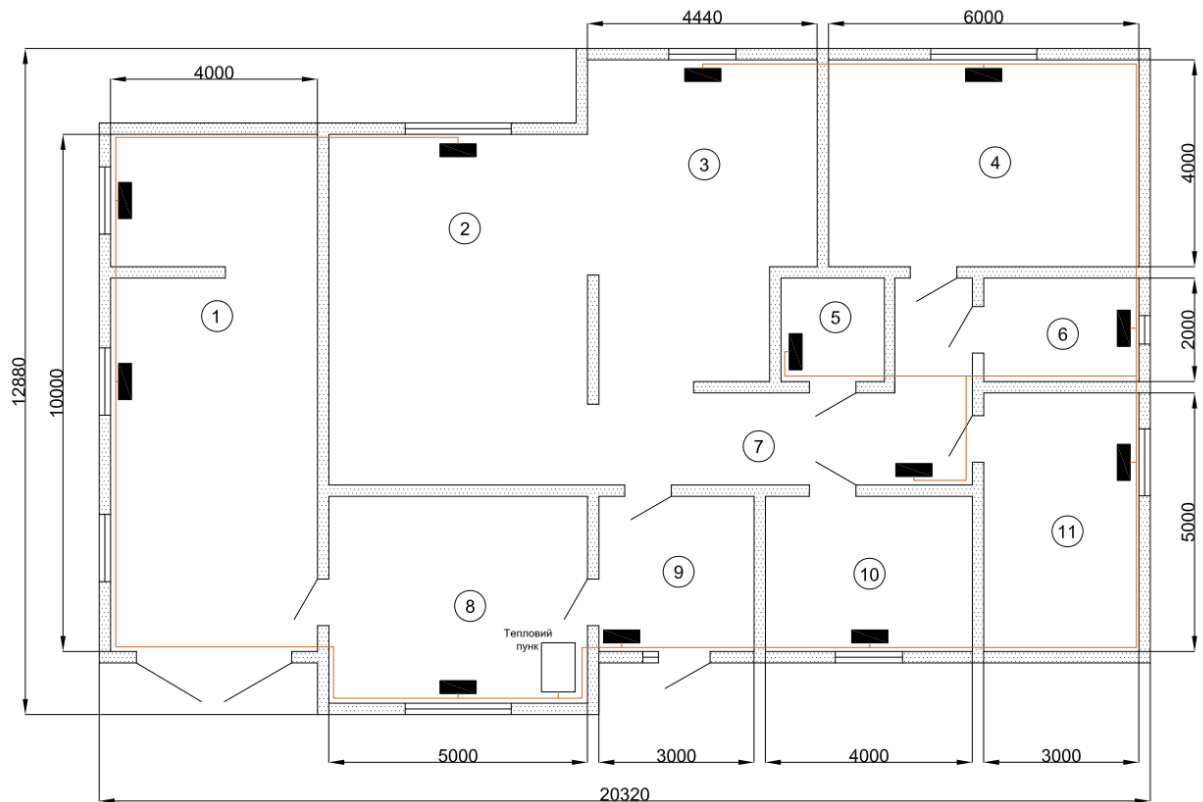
План будинку із зображенням теплового пункту та опалювальних приладів.
